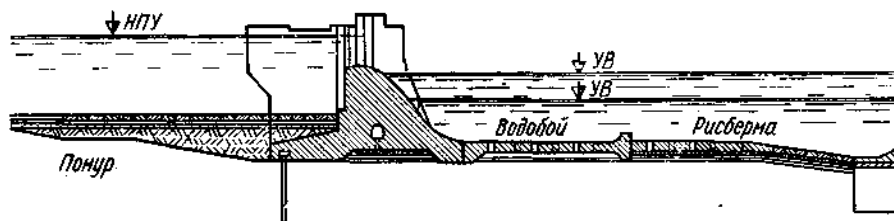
Водосливная бетонная плотина на не скальном основании
